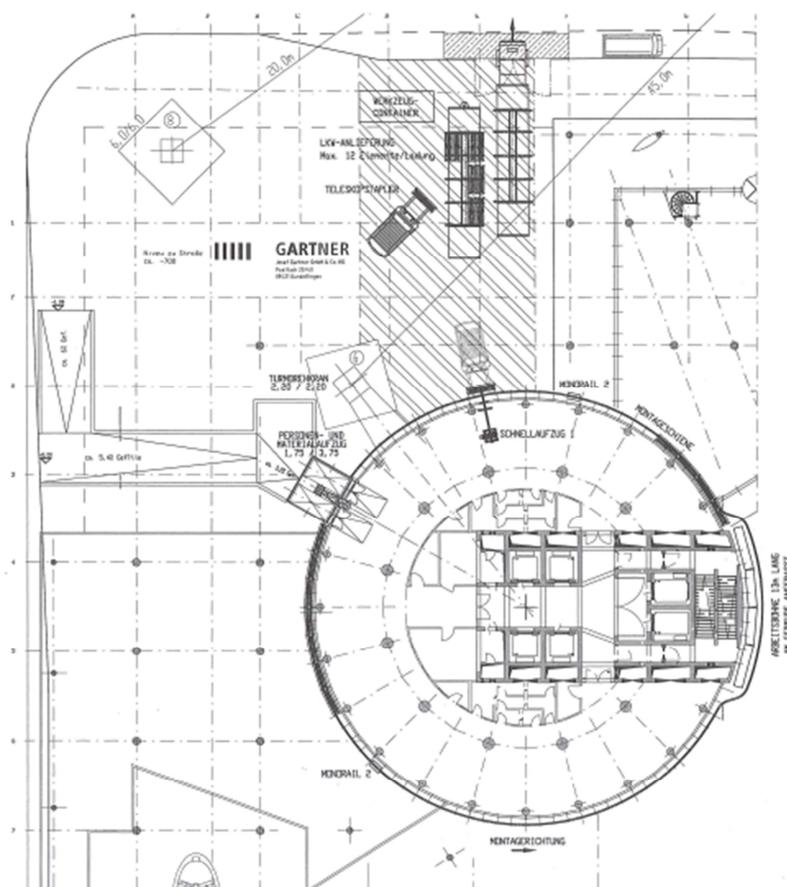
Baustellenlageplan Business Tower, Nürnberg<sup>181</sup>
